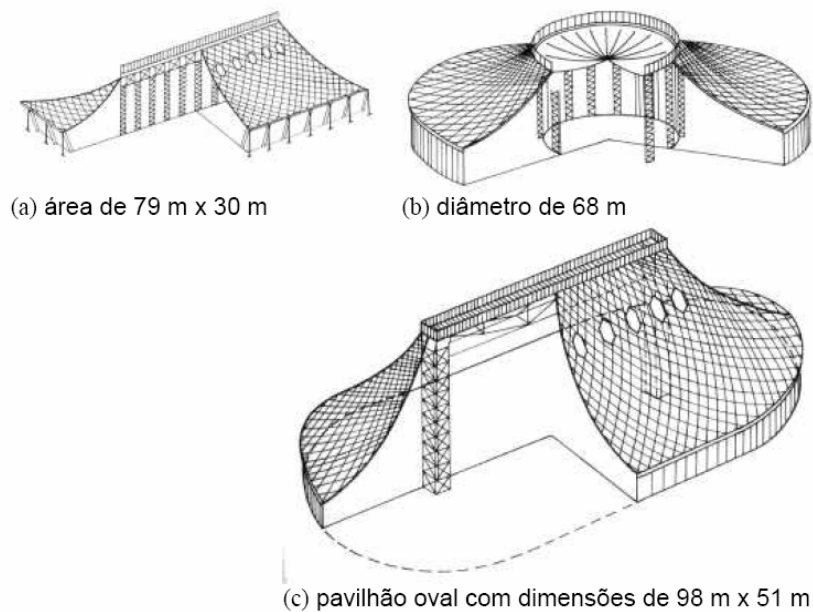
Pavilhões construídos por Shookhov, adaptada de [1].
